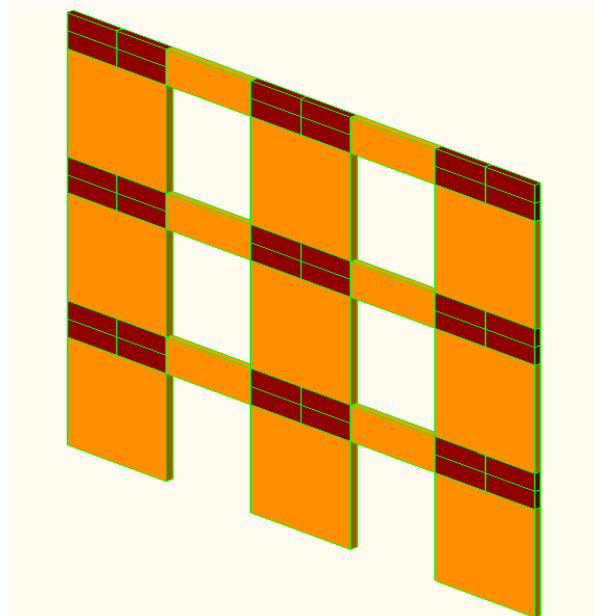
Vista 3D parete a tre piani in CLT
